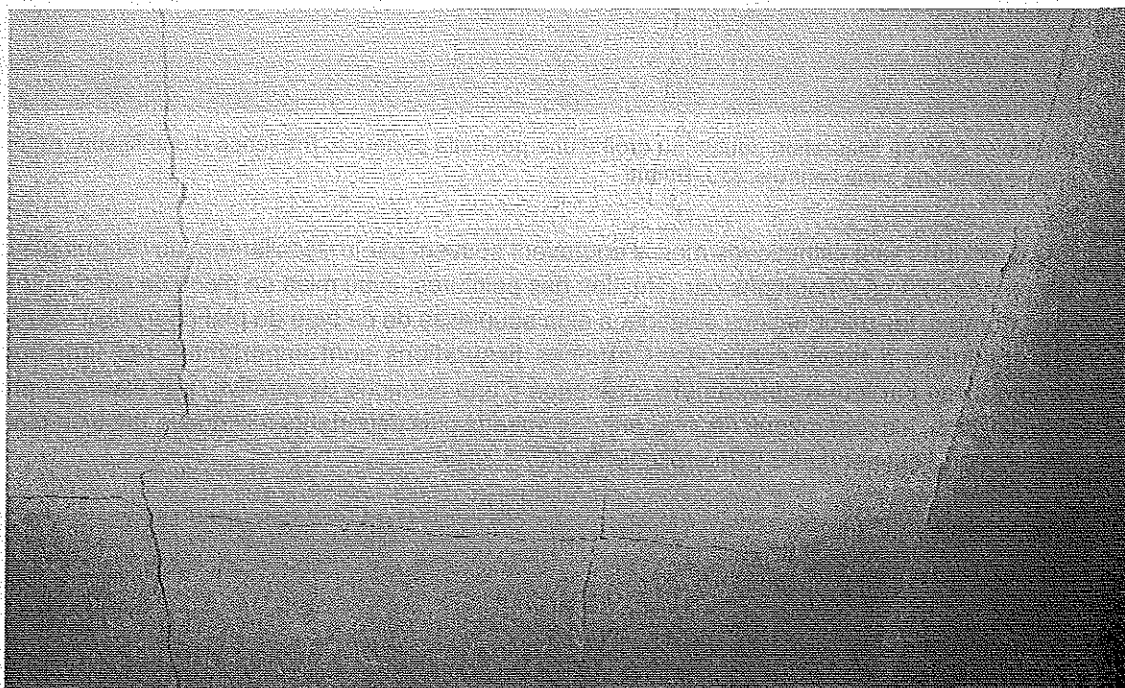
Fissuration d'un ancien plancher métallique à poutrelles (enduit plâtre en sous-face). © J. Putatti
